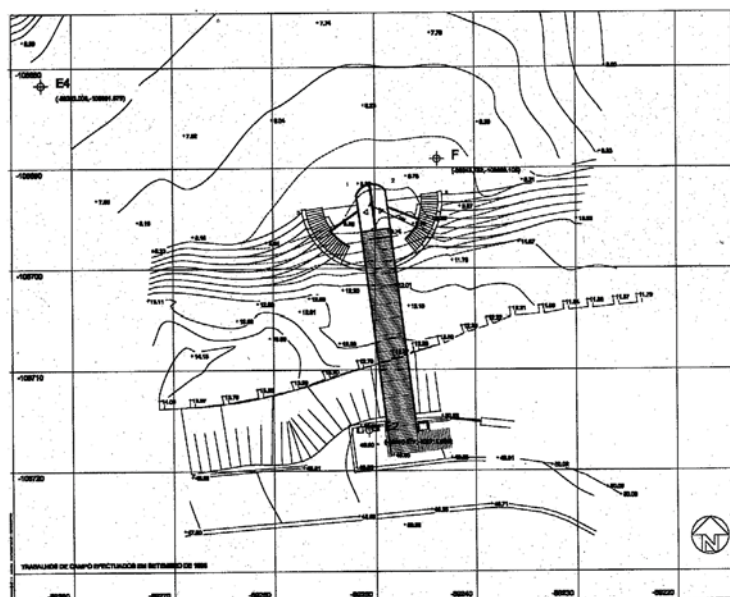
Implantação do elevador, in Arquitetura e Vida.
